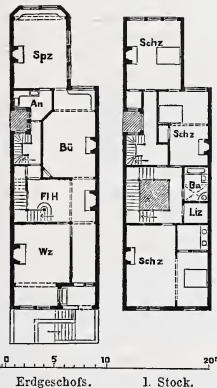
Haus für eine 25 Fuß-Stadt-Baustelle.
